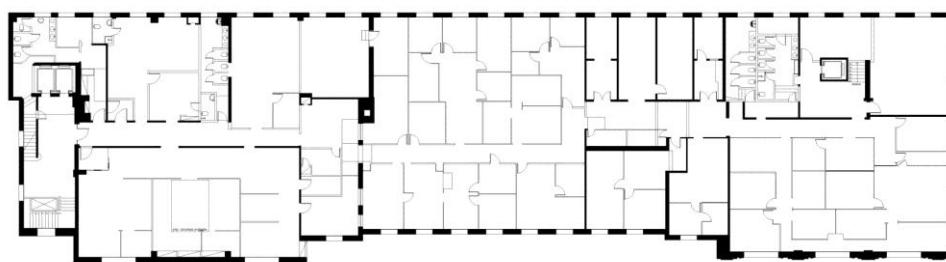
Planta baixa, 4º pavimento – Situação atual
